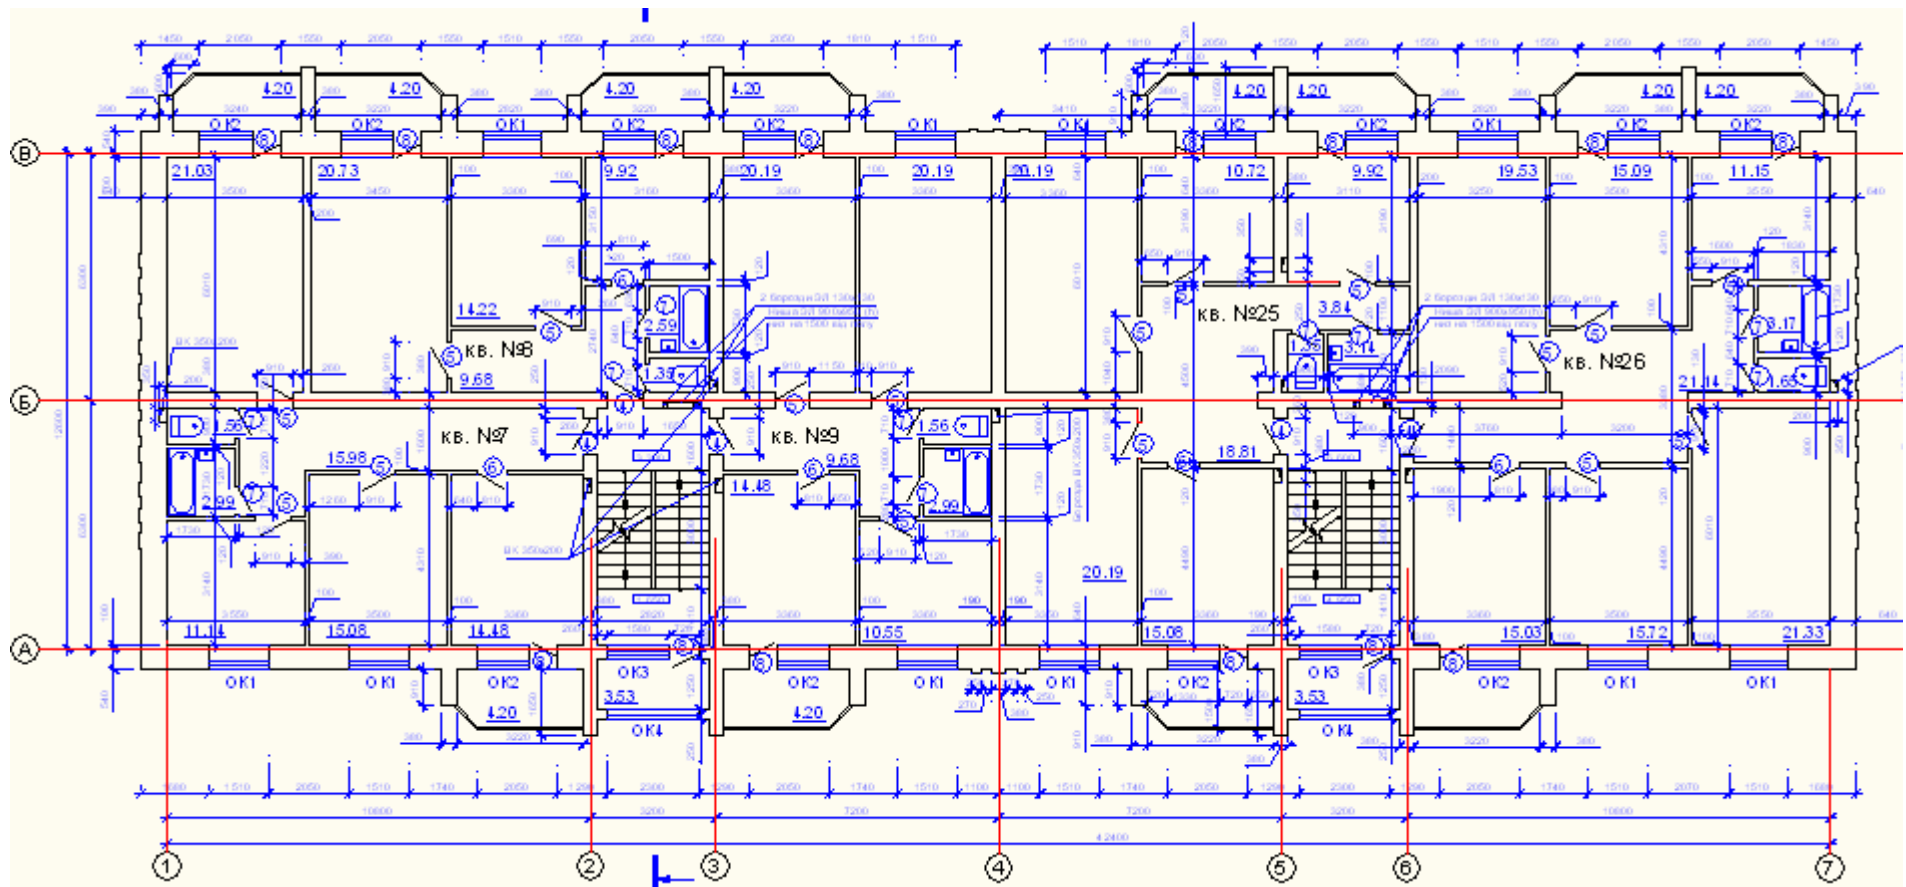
Кладочний план типового поверху розглянутої будівлі
